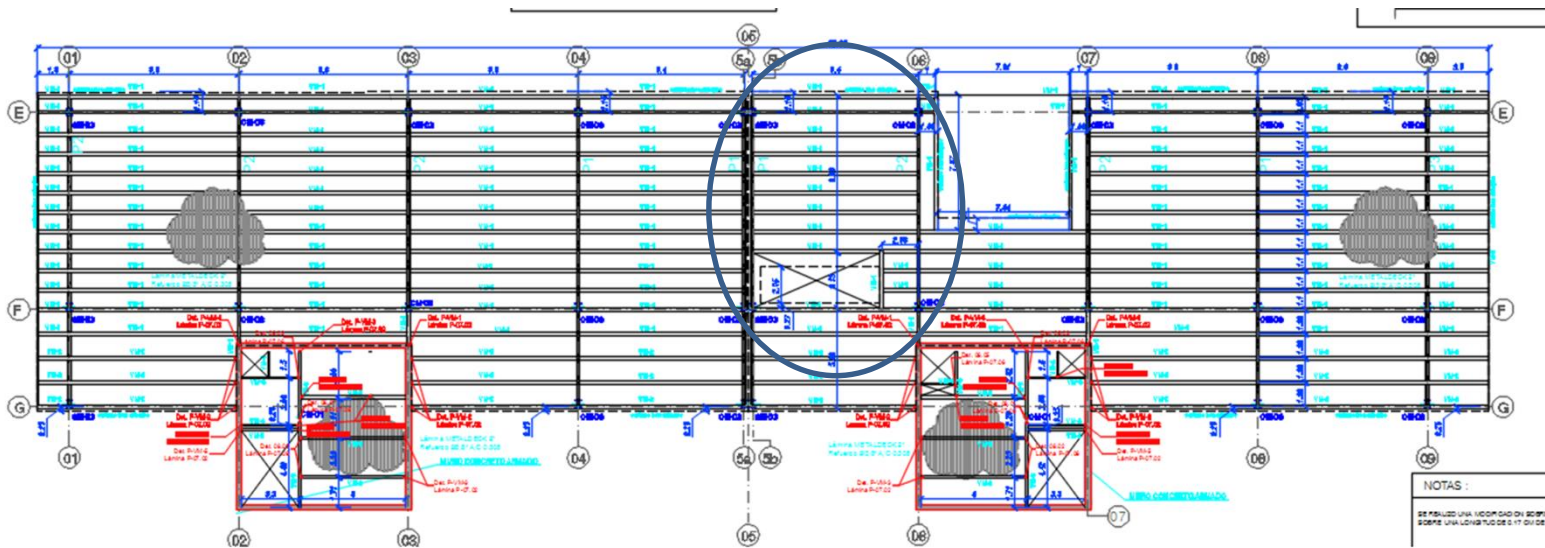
Lamina planta estructural de techo entre eje F y eje E
